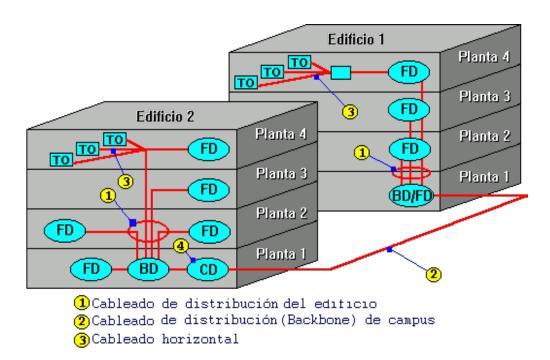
Arquitectura d'un sistema cablejat estructurat.
